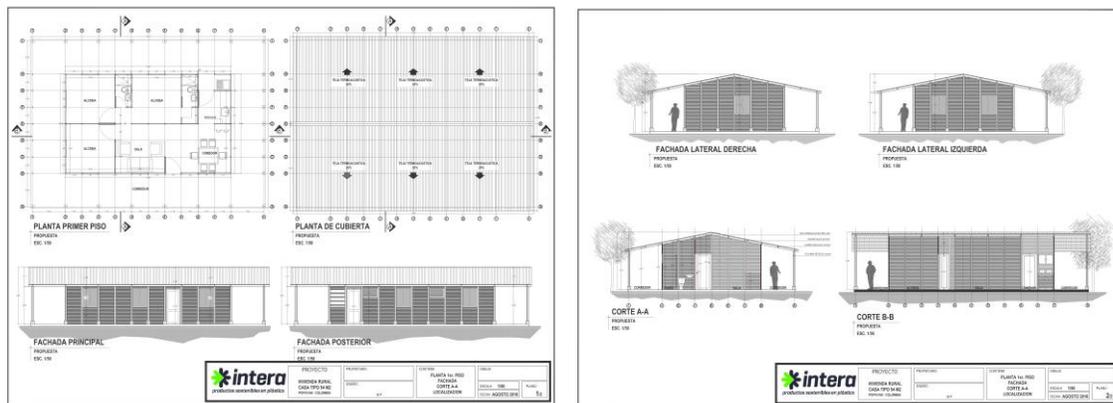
Planta Distribución Vivienda Rural 66 m<sup>2</sup> Con Corredor. Fuente: Elaboración propia.
